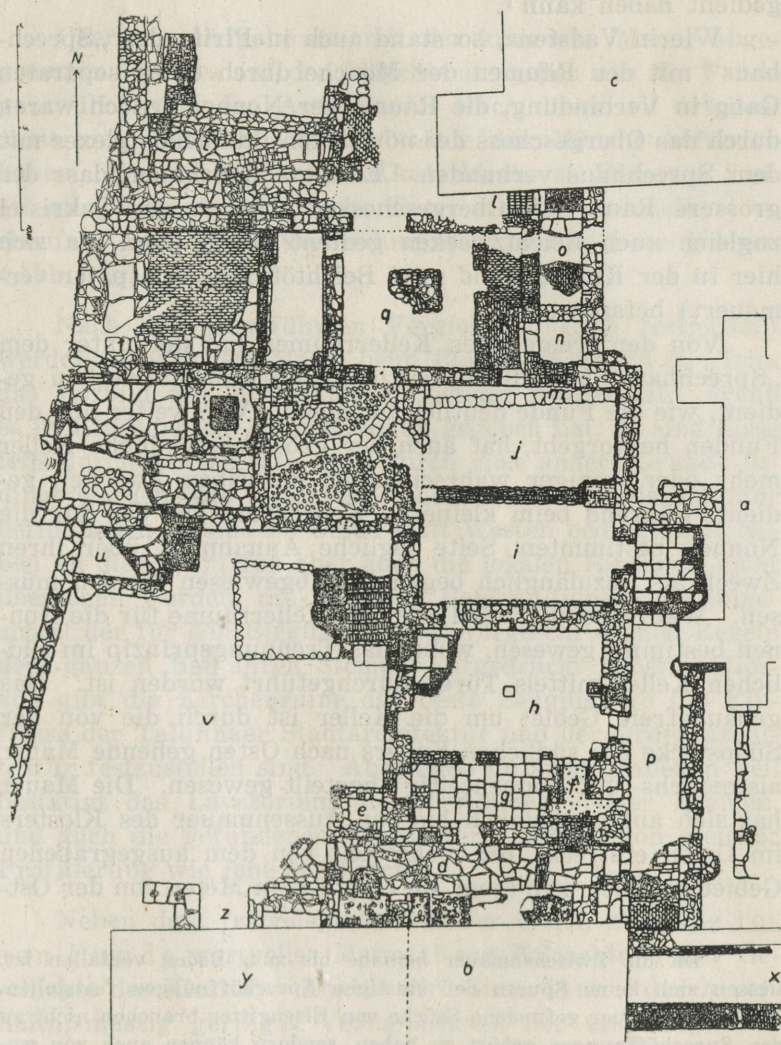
Grundriss der 1926 u. 1927 freigelegten Räume hinter dem Westchor der Klosterkirche zu Vadstena. Nach B. Berthelson (Fornvännen 1928).
